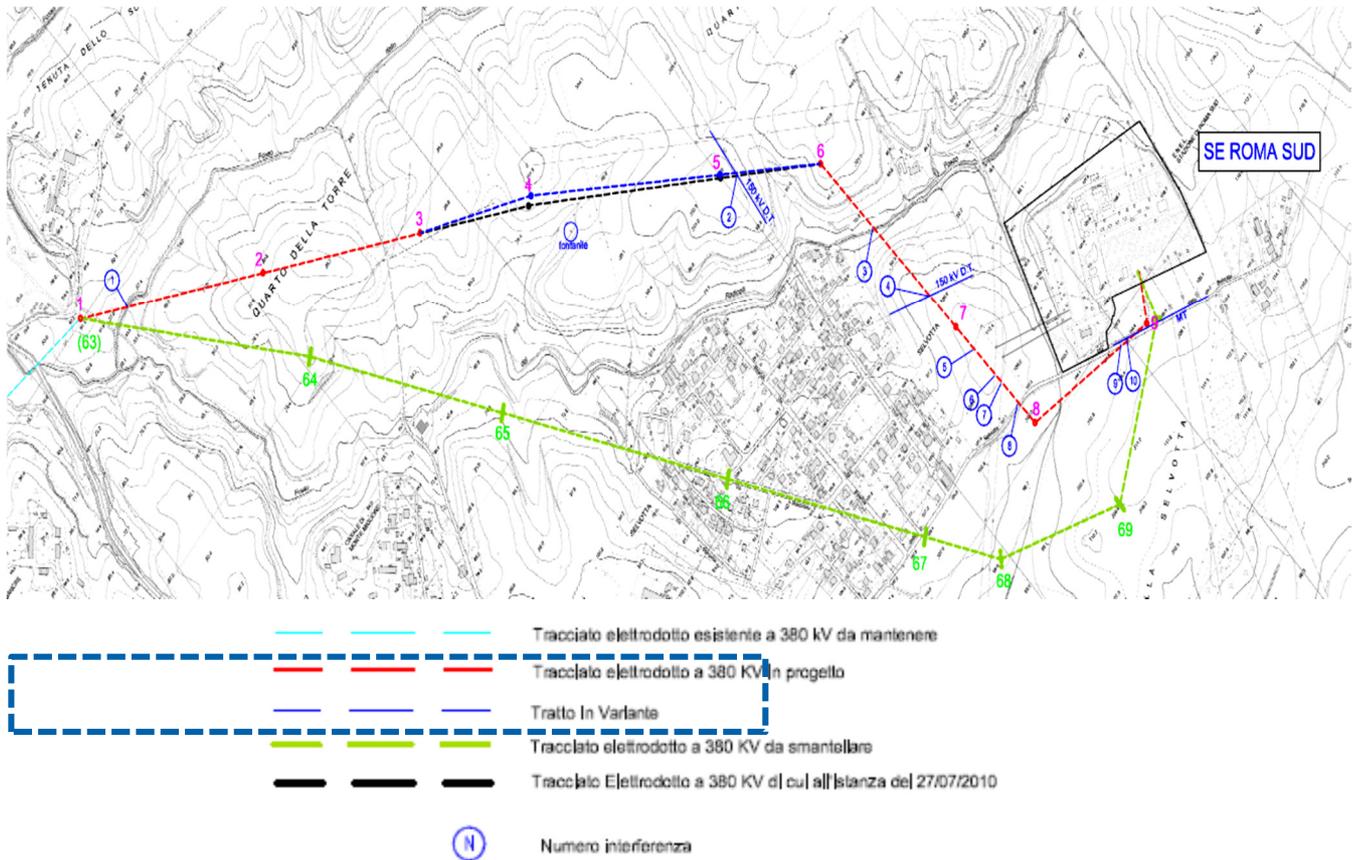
Ottimizzazione planimetrica per interferenza con il Fontanile della Torre
